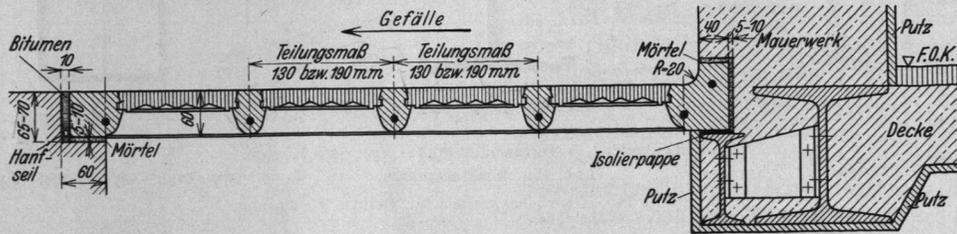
Begehbare Glasbeton-Oberlicht über einem Lichtgraben.
